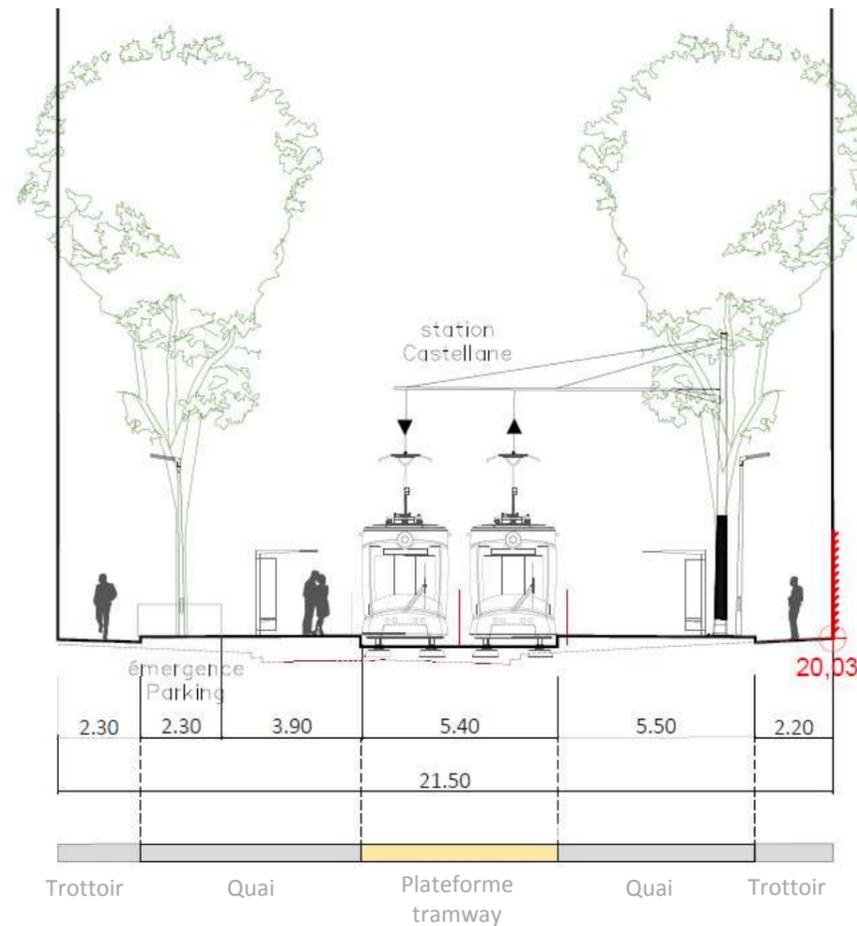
Profil en travers au niveau de la station Castellane sur l'avenue Cantini
